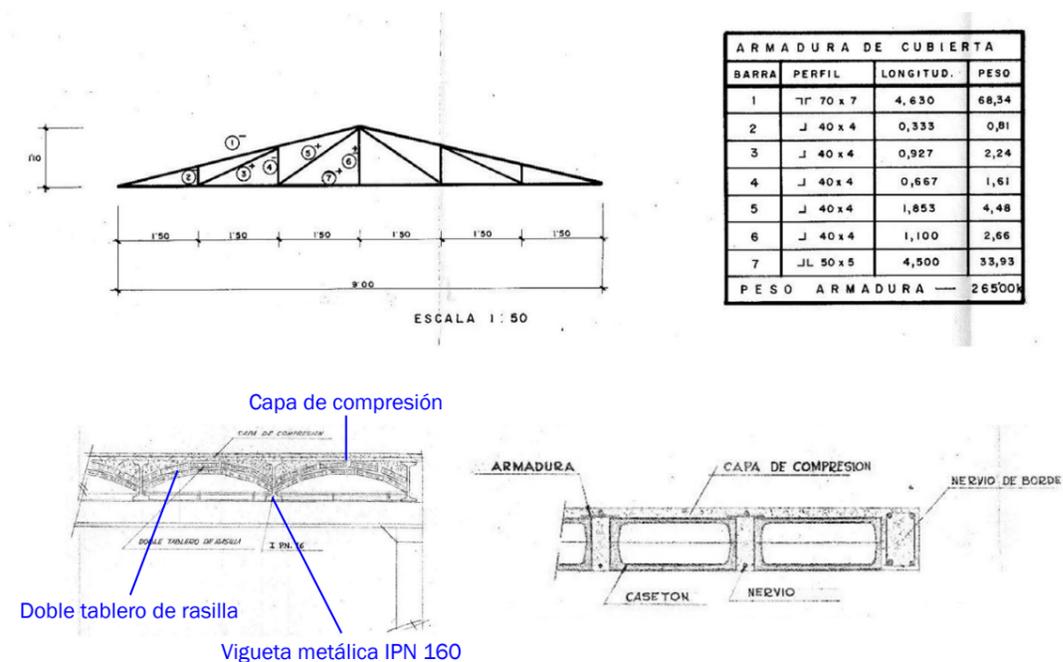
Detalles constructivos de Lechezul. De arriba a abajo y de izquierda a derecha, (arriba) esquema de cubiertas con tabla de las armaduras, escala 1:50; (izquierda) detalle del forjado unidireccional de viguetas de la entreplanta, escala 1:10; y (derecha) detalle de hormigón armado de casetones no recuperables, escala 1:10
